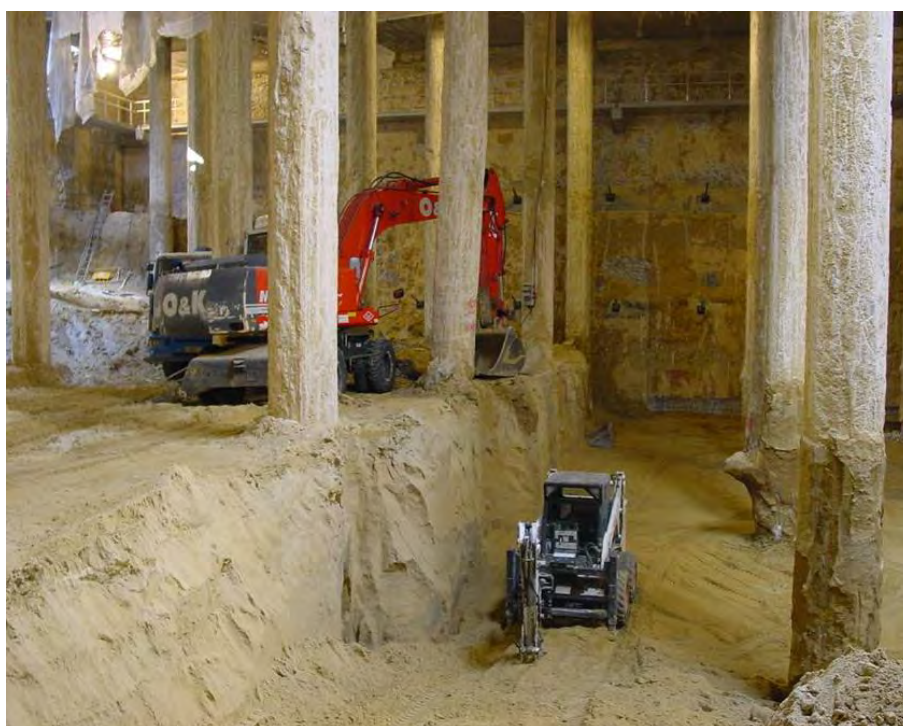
Construcción invertida de tanques. Excavación del tanque bajo cubierta
